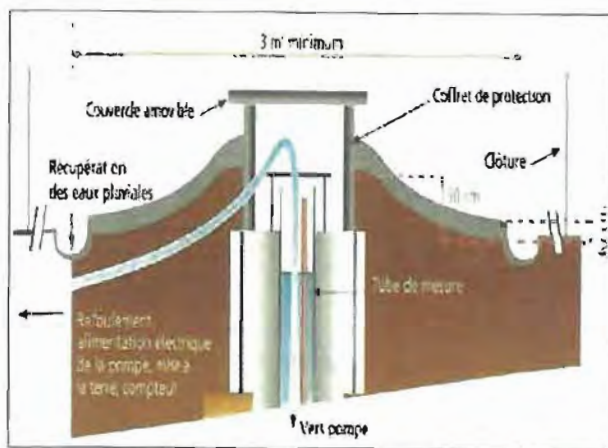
Dispositions techniques pour la création d'un forage d'eau (Plaquette éditée par le BRGM)
